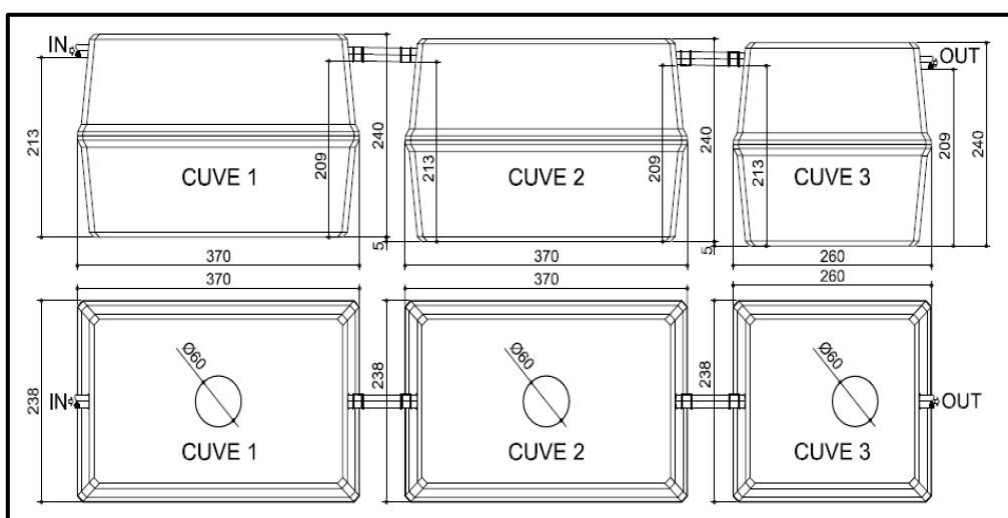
Plan d'encombrement de l'Oxyfix® C-90 CB 75EH
